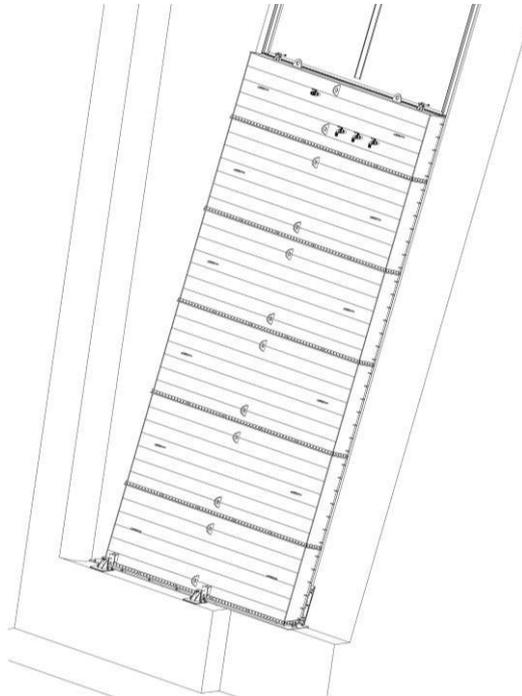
batardage par 6 éléments horizontaux sur la prise d'eau du barrage de Nangbeto (Togo)
